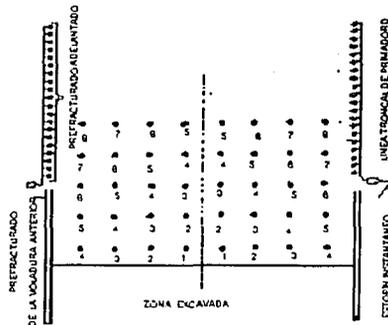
Procedimiento de explosiones retrasadas durante la voladura principal en el Prefracturado.
